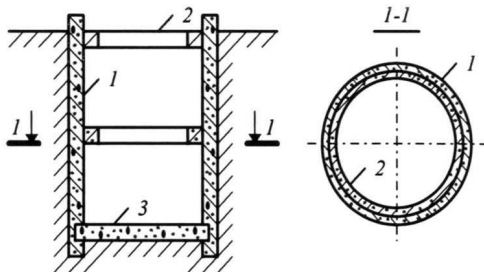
Споруда з розпірними залізобетонними поясами:
